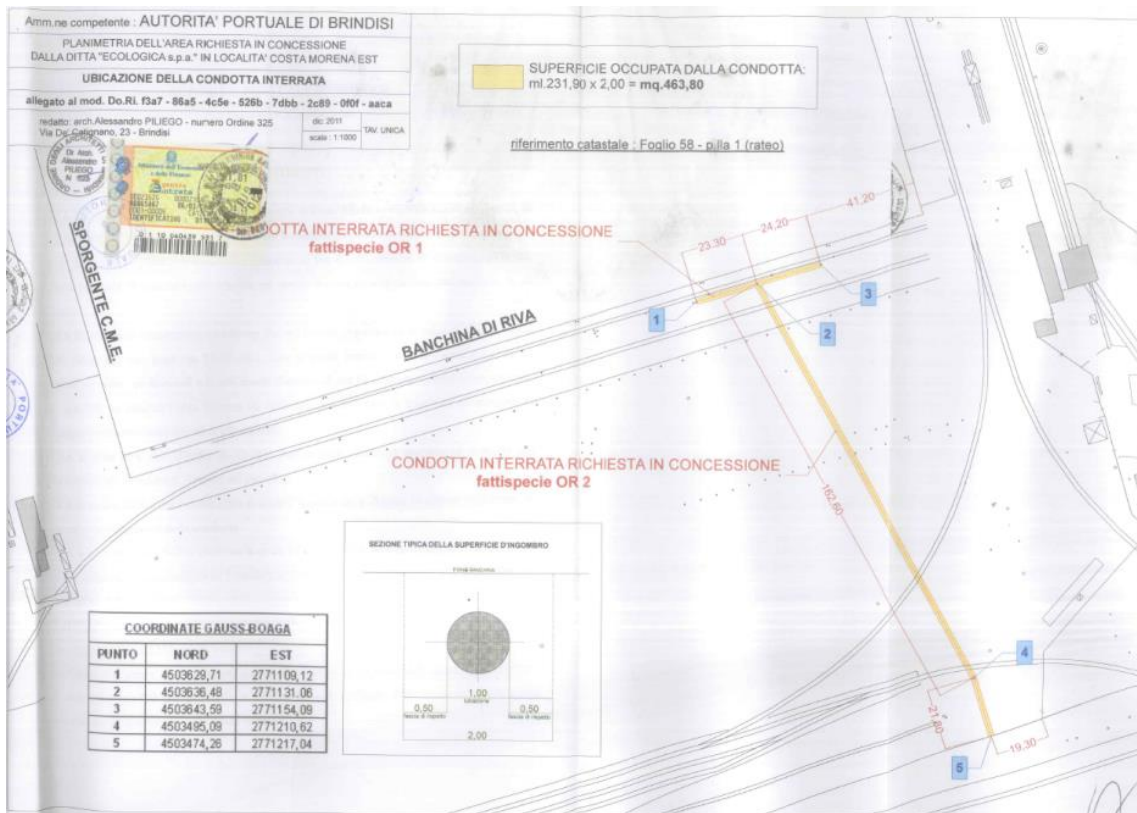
STRALCIO PLANIMETRICO CONDOTTA IN AREA DEMANIALE
